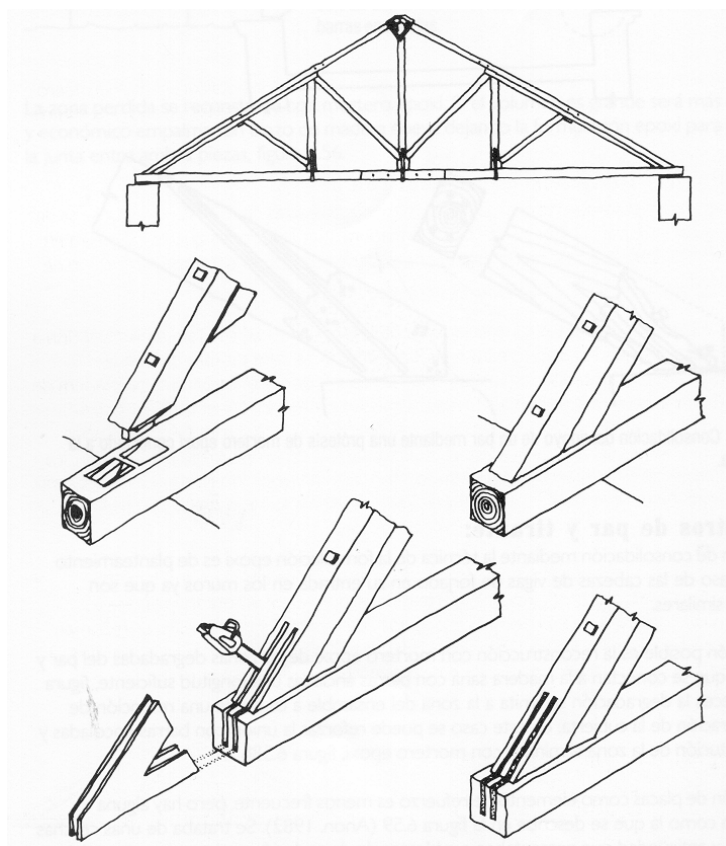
Reforço de nós nas estruturas de madeira com barras coladas (Arriaga, 2002)
